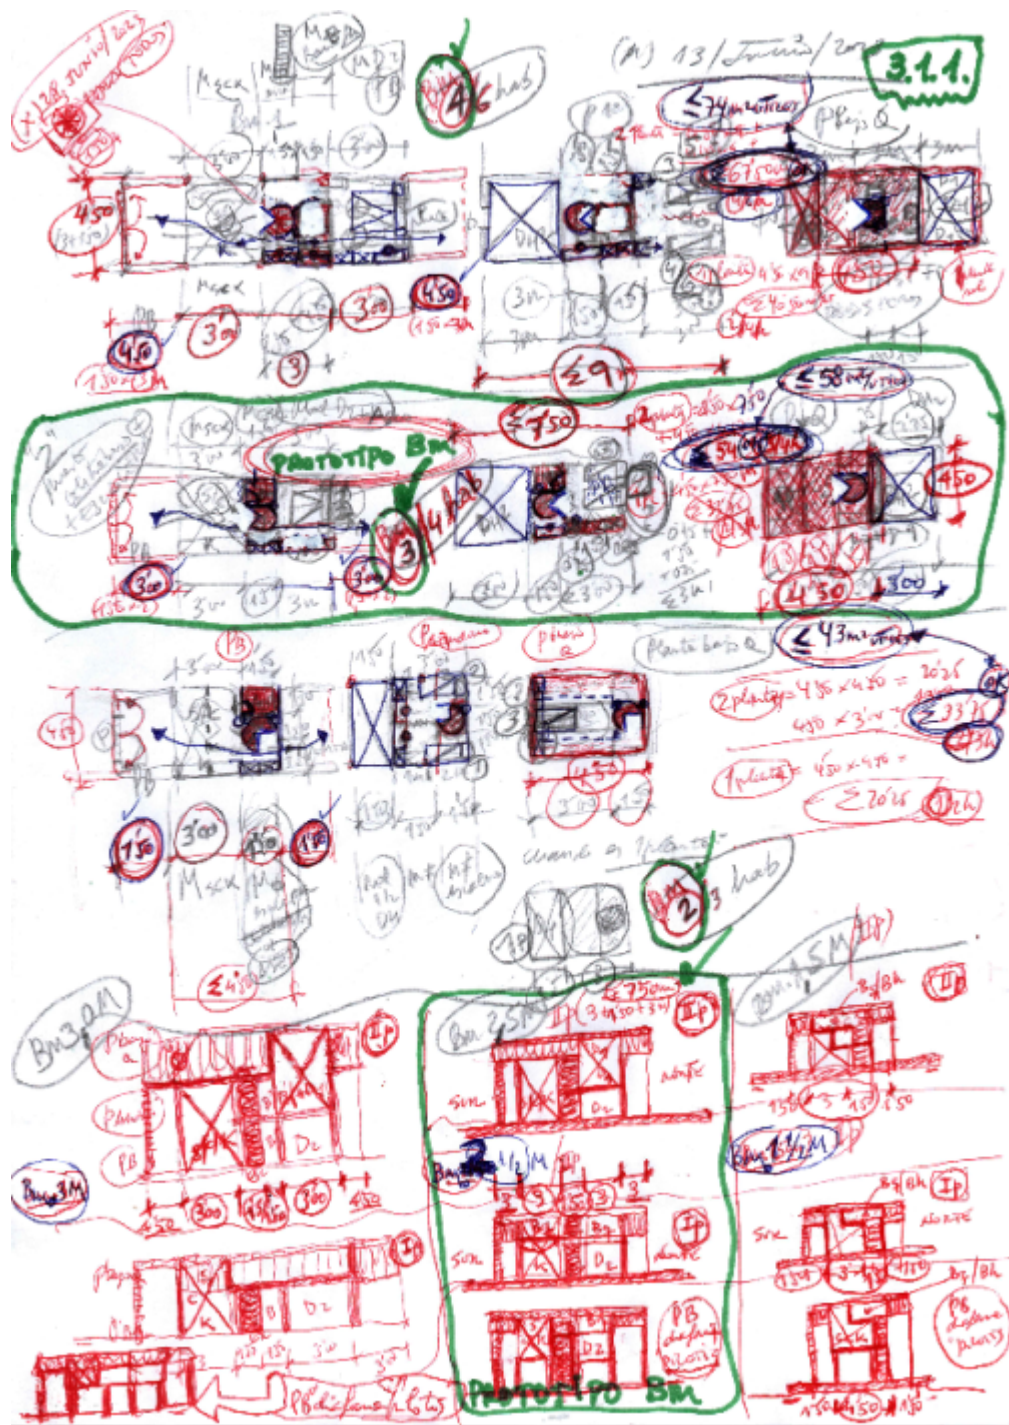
/ 1: Croquis previos de plantas y secciones de los prototipos y sus posibles versiones en dos plantas, más bajo cubierta.
